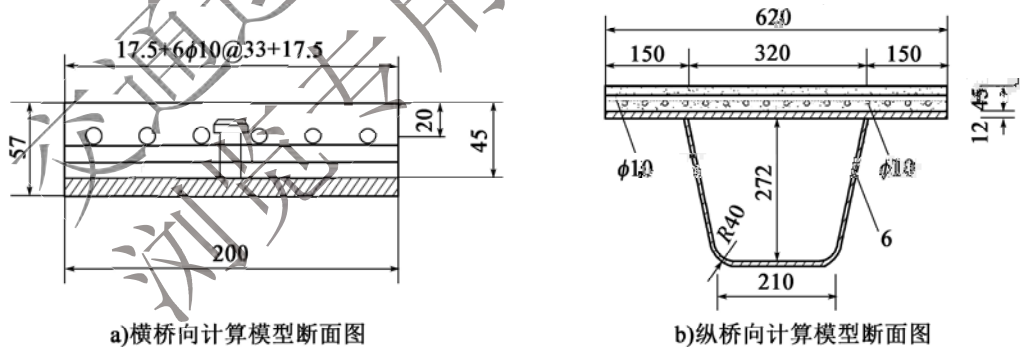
条带模型构造示意（尺寸单位：mm）
